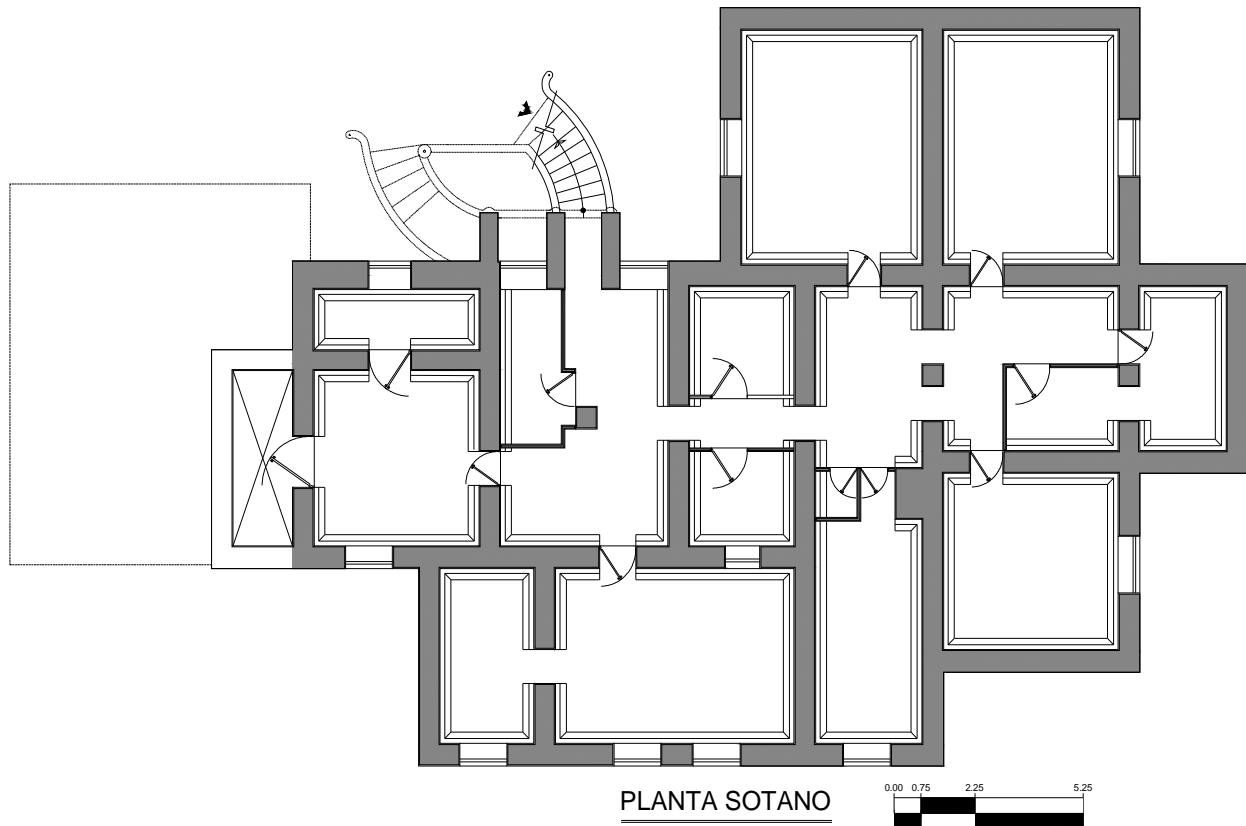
Planta arquitectónica, nivel sótano de la Casa Otelo.
